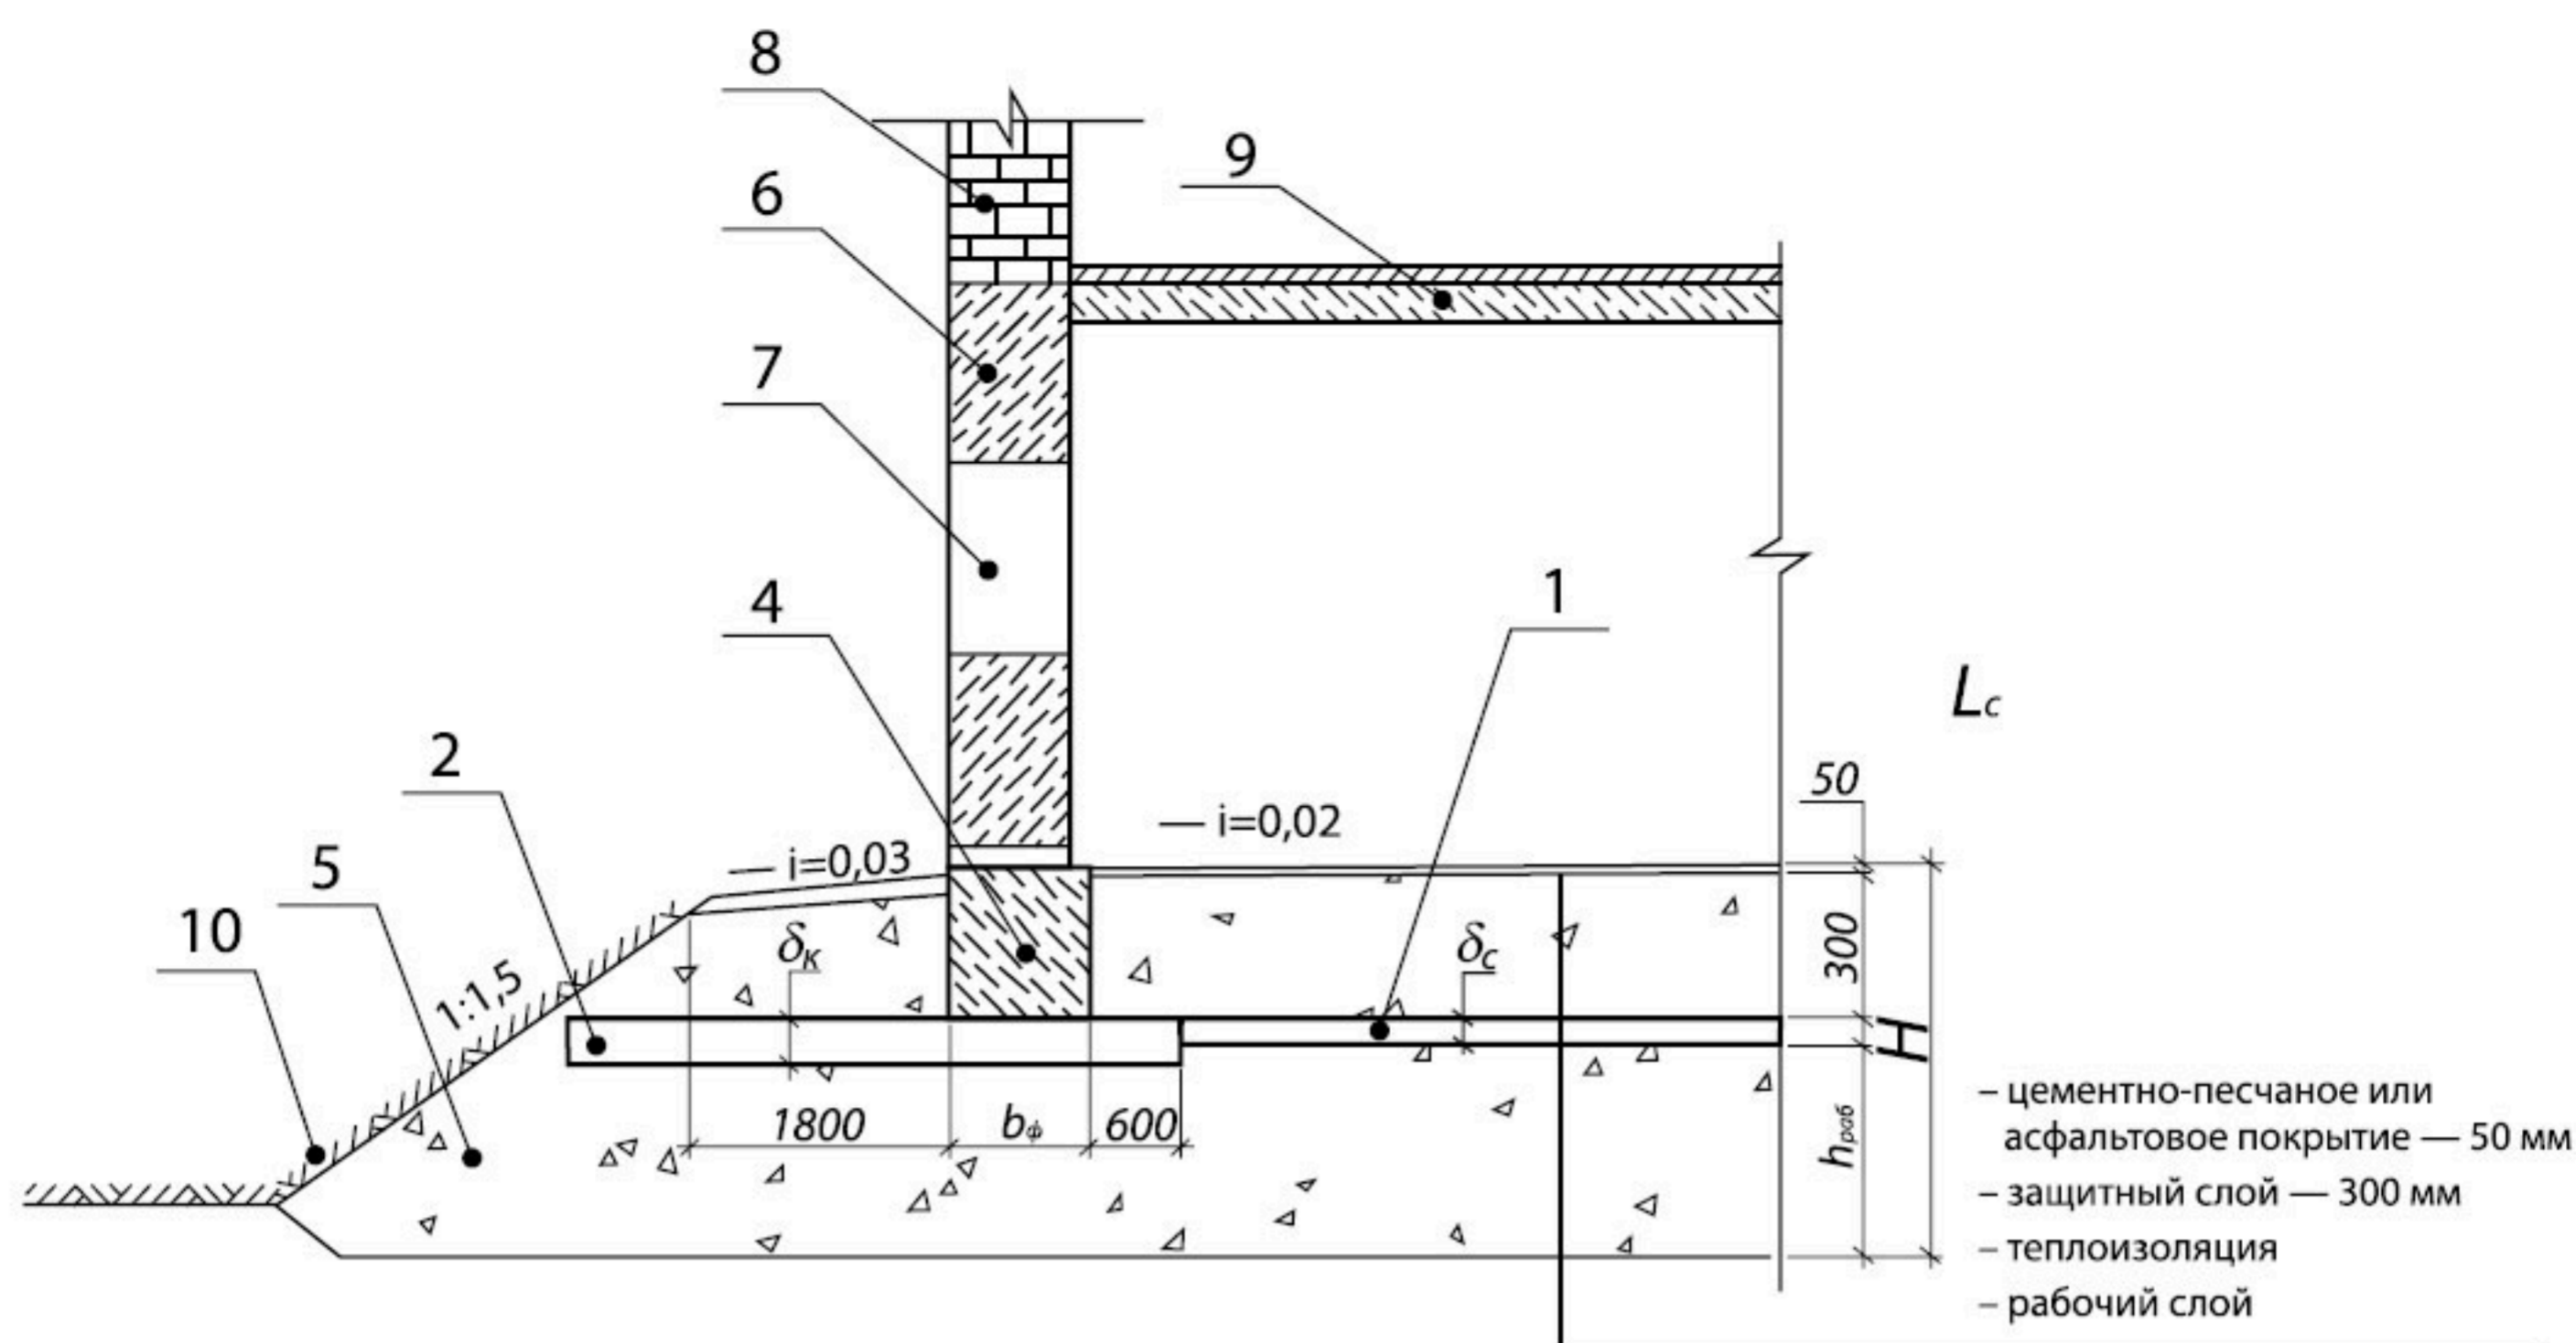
Схема обустройства фундамента на вечномёрзлом грунте с XPS теплоизоляцией. Разрез вентилируемого подполья здания с фундаментом
